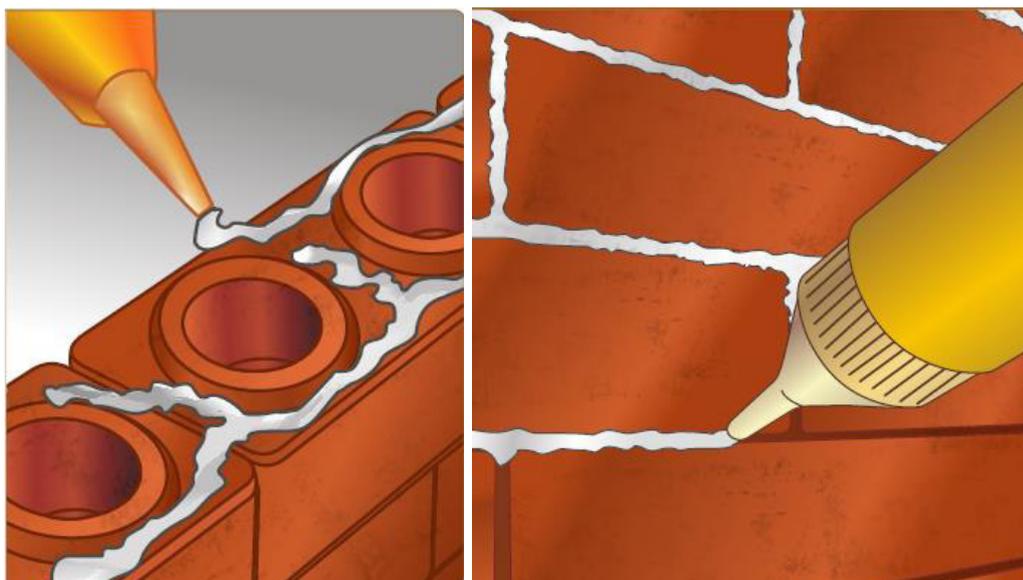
Aplicação da cola para junção dos tijolos. Fonte: Manual Prático Eco Produção tijolos ecológicos, s.d., montagem da autora, 2016.
